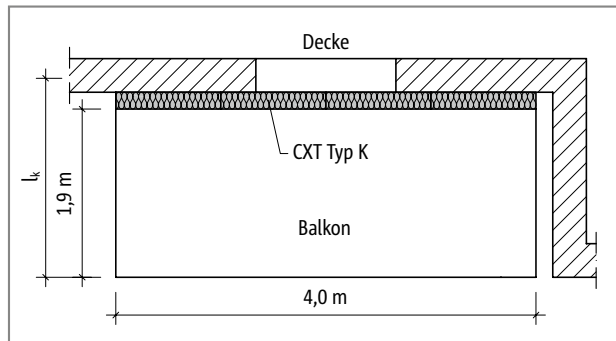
Schöck Isokorb® CXT Typ K: Grundriss
